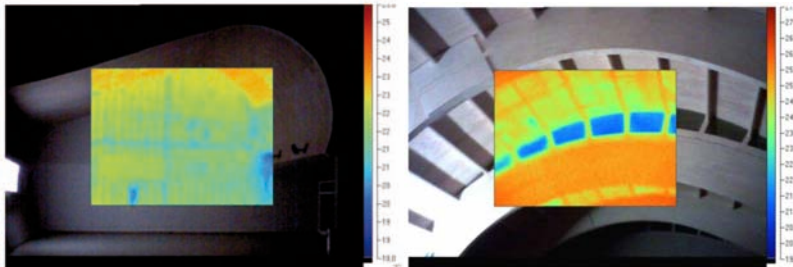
Termografía infrarroja muros fachada oriente correspondiente a oficinas cubierta.
